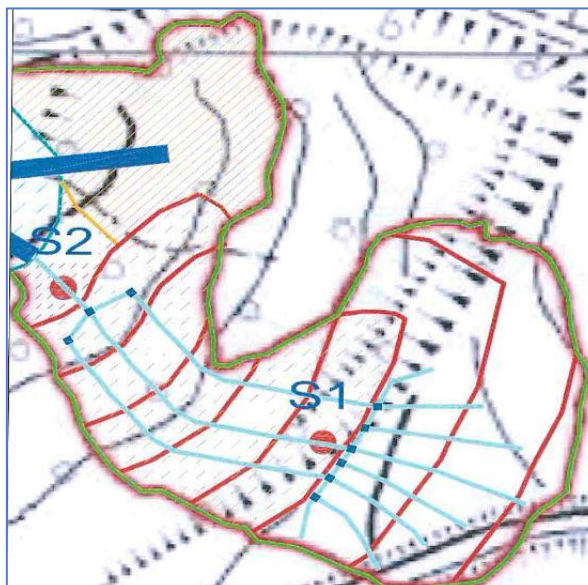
Planimetria progetto esecutivo dell' Ing. D. Manfredini (Feb. 2016).
